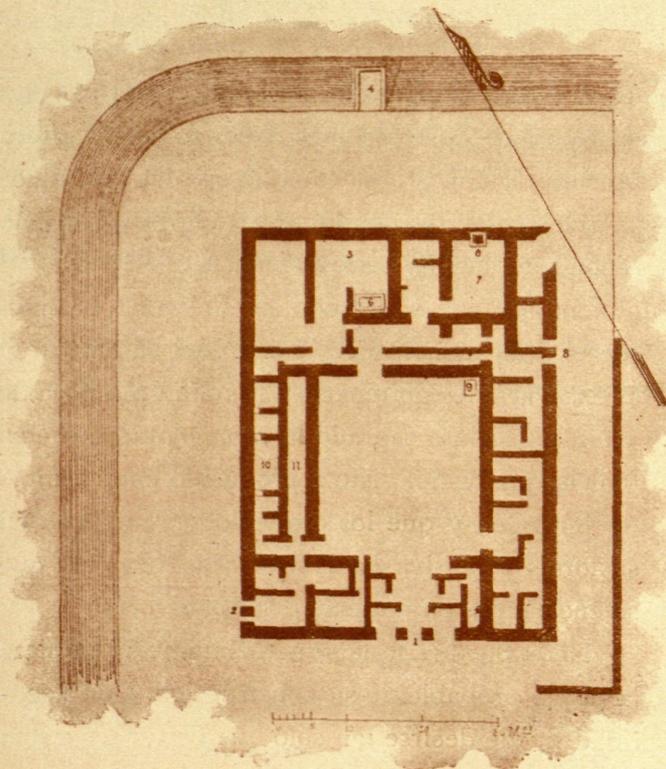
PLANTA DEL PALACIO DE BOGHAZ-KEUI, SEGÚN BARTH
